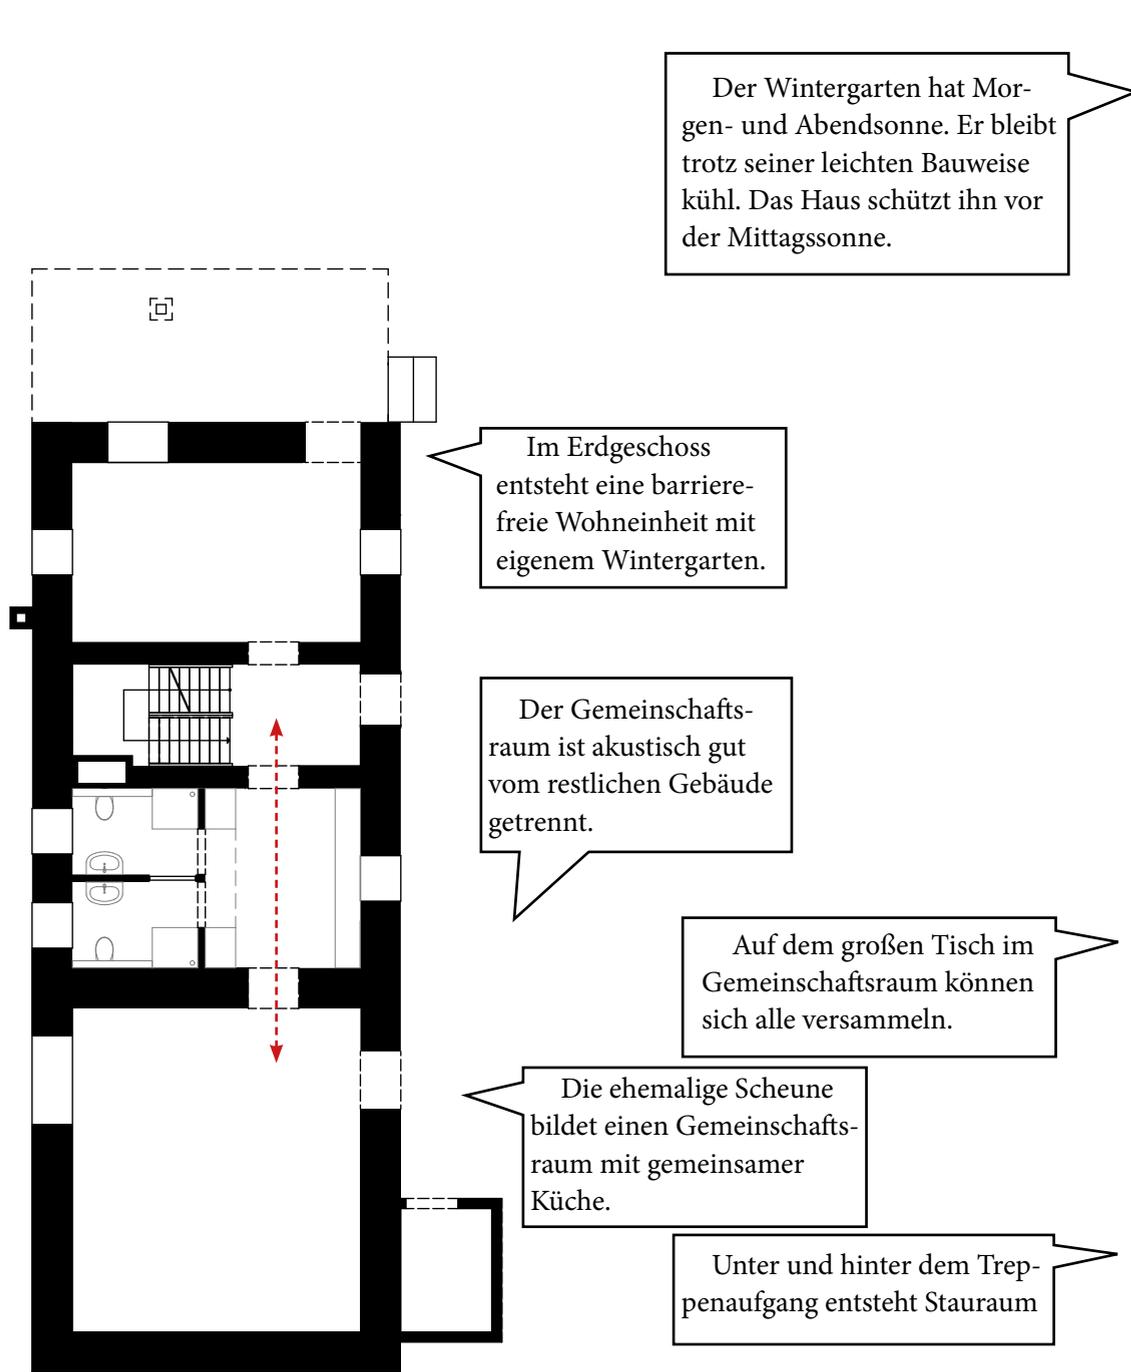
Grundriss Erdgeschoss 1:150
